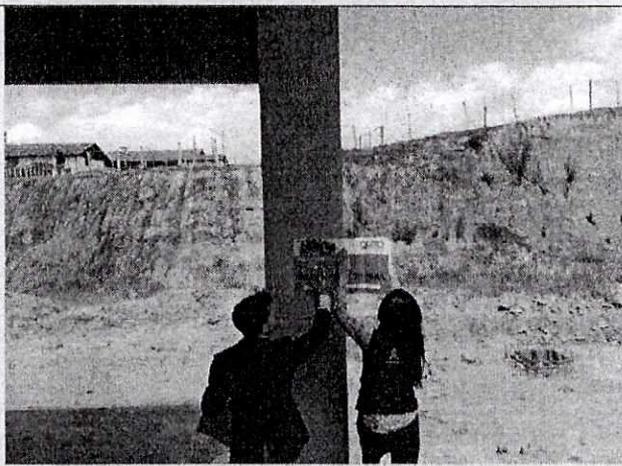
Colocación de sello de suspensión en el acceso – ubicación posterior de la edificación.
